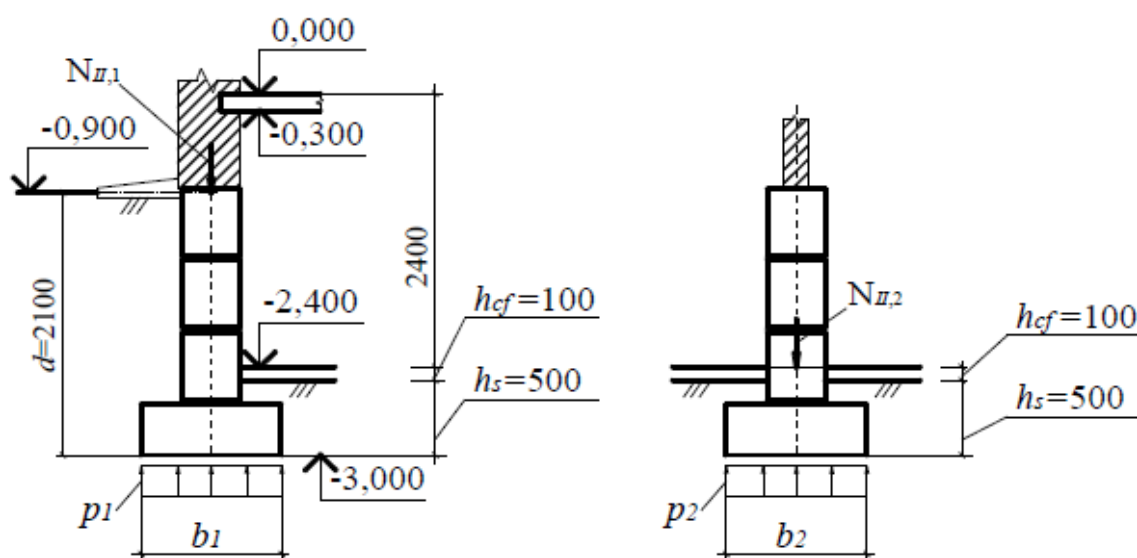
Схема к определению размеров подошвы фундаментов гражданского здания (пример 4)
